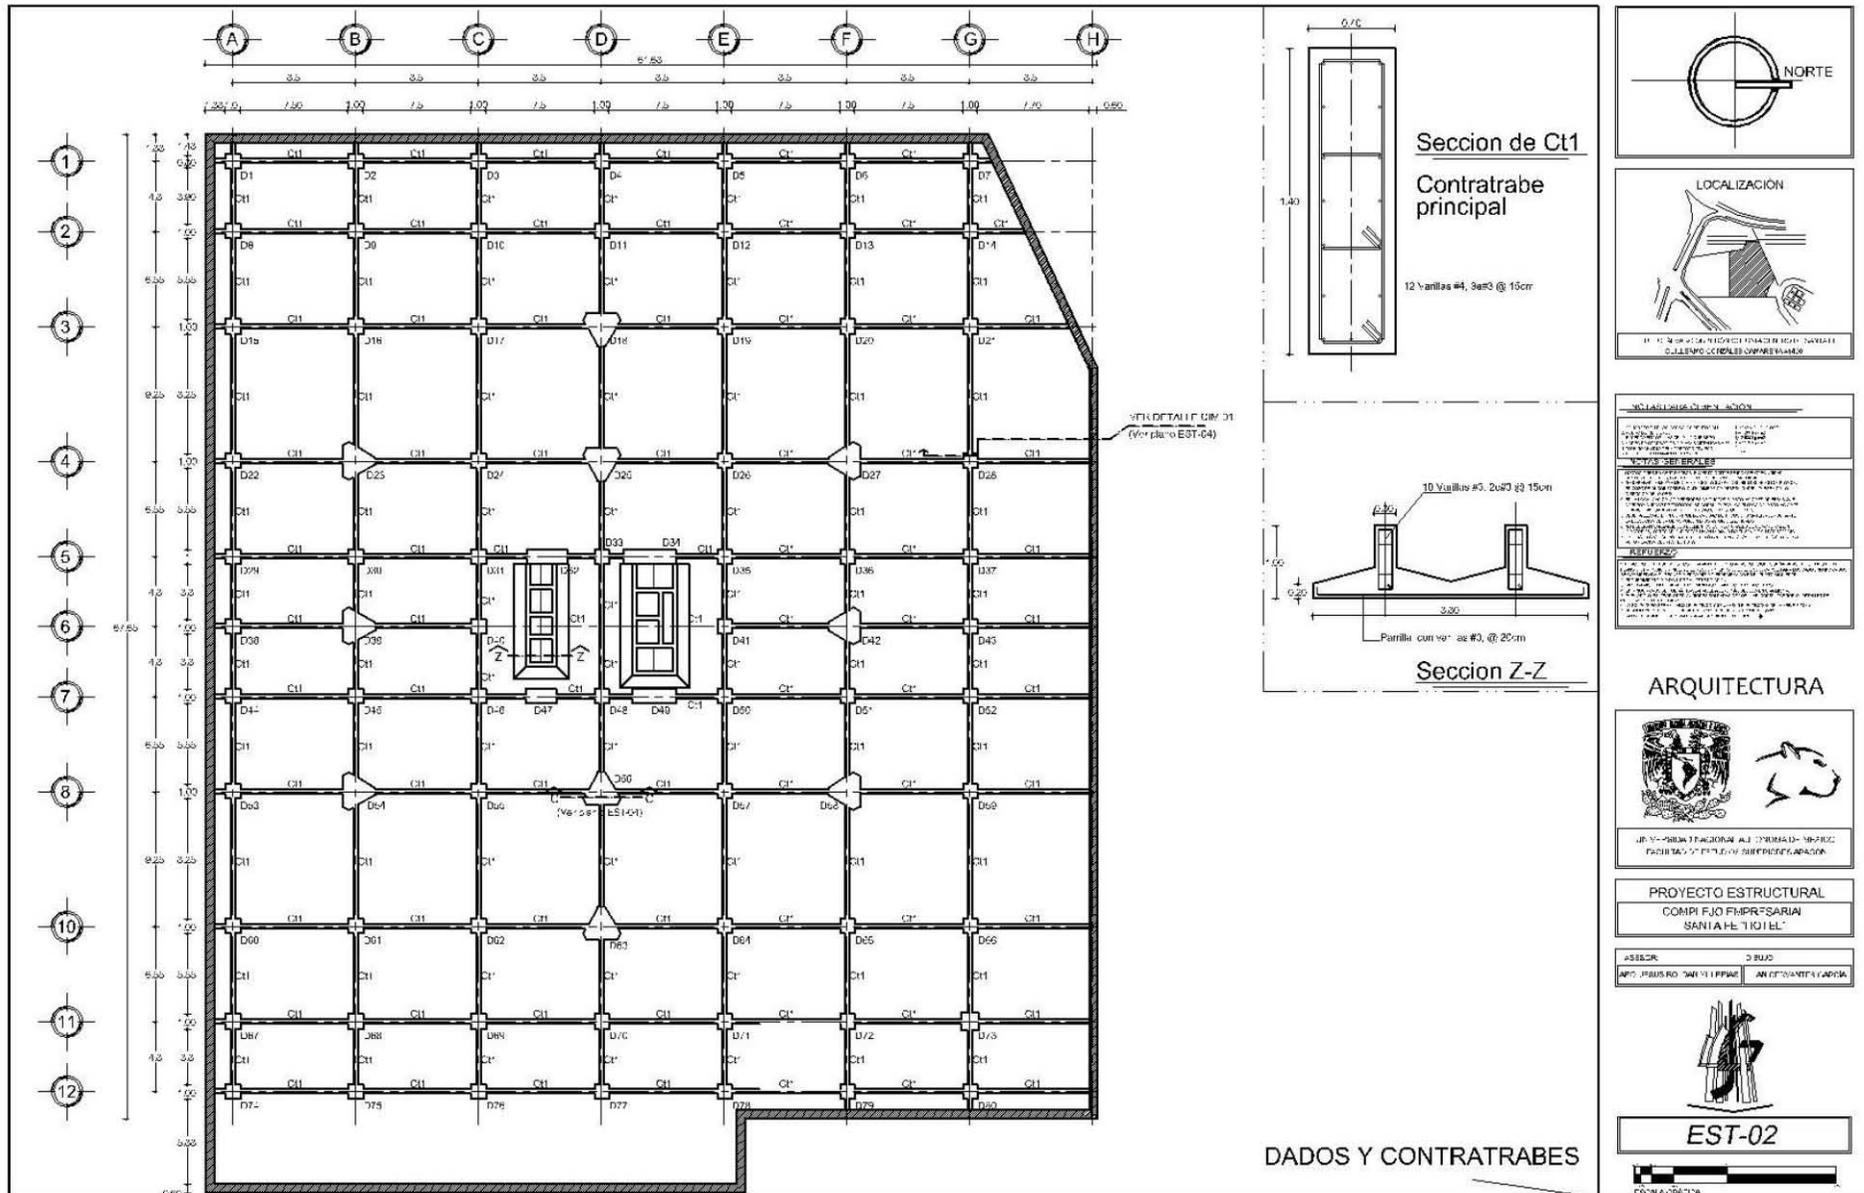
Plano Est-02; Ubicación de dados y contra-trabes. Edición propia.
